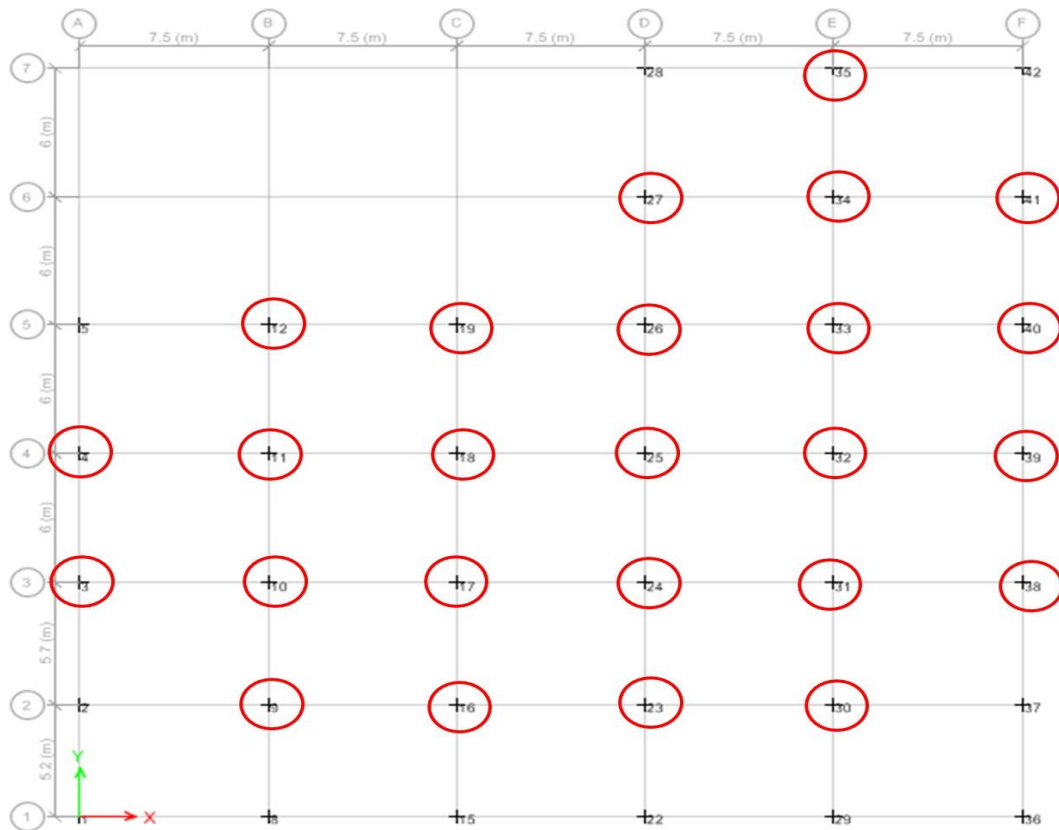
Ubicación de aisladores sísmicos en la Estructura B
